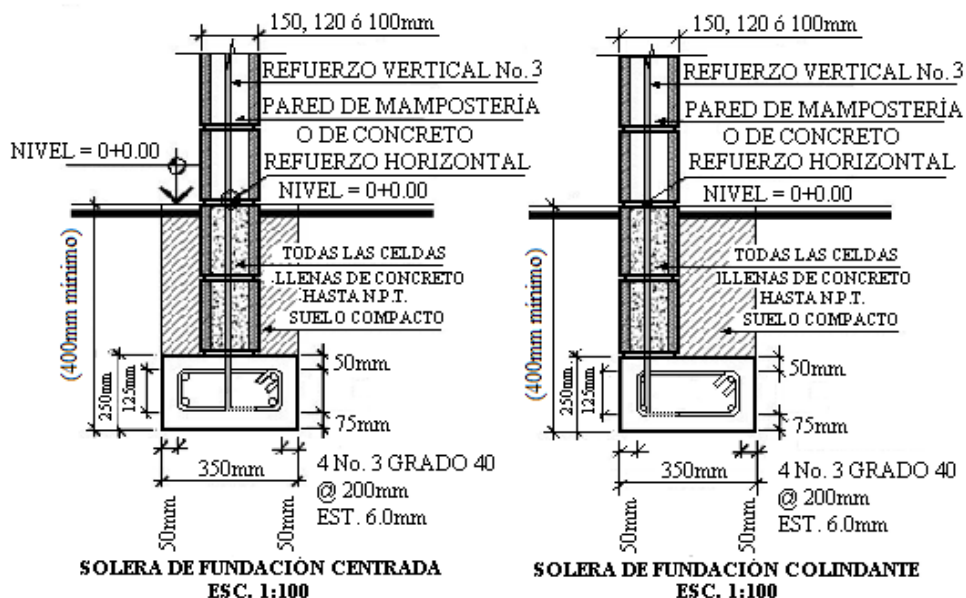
Requisito mínimo para solera de fundación en vivienda de una planta
